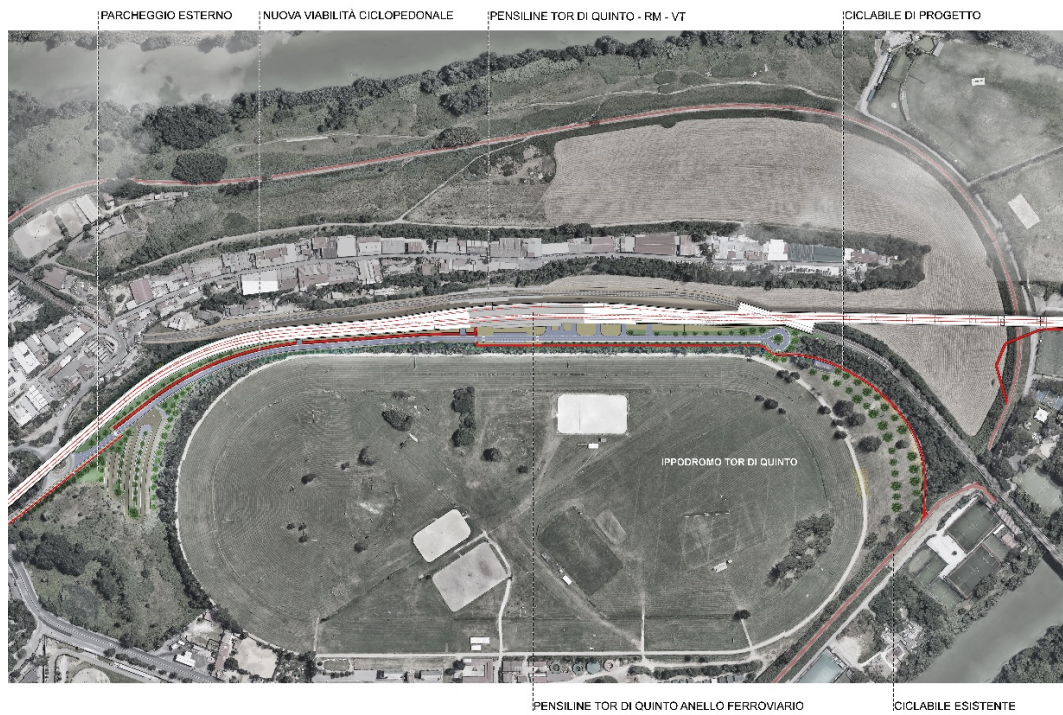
Planimetria generale di progetto – Stazione di Tor di Quinto
